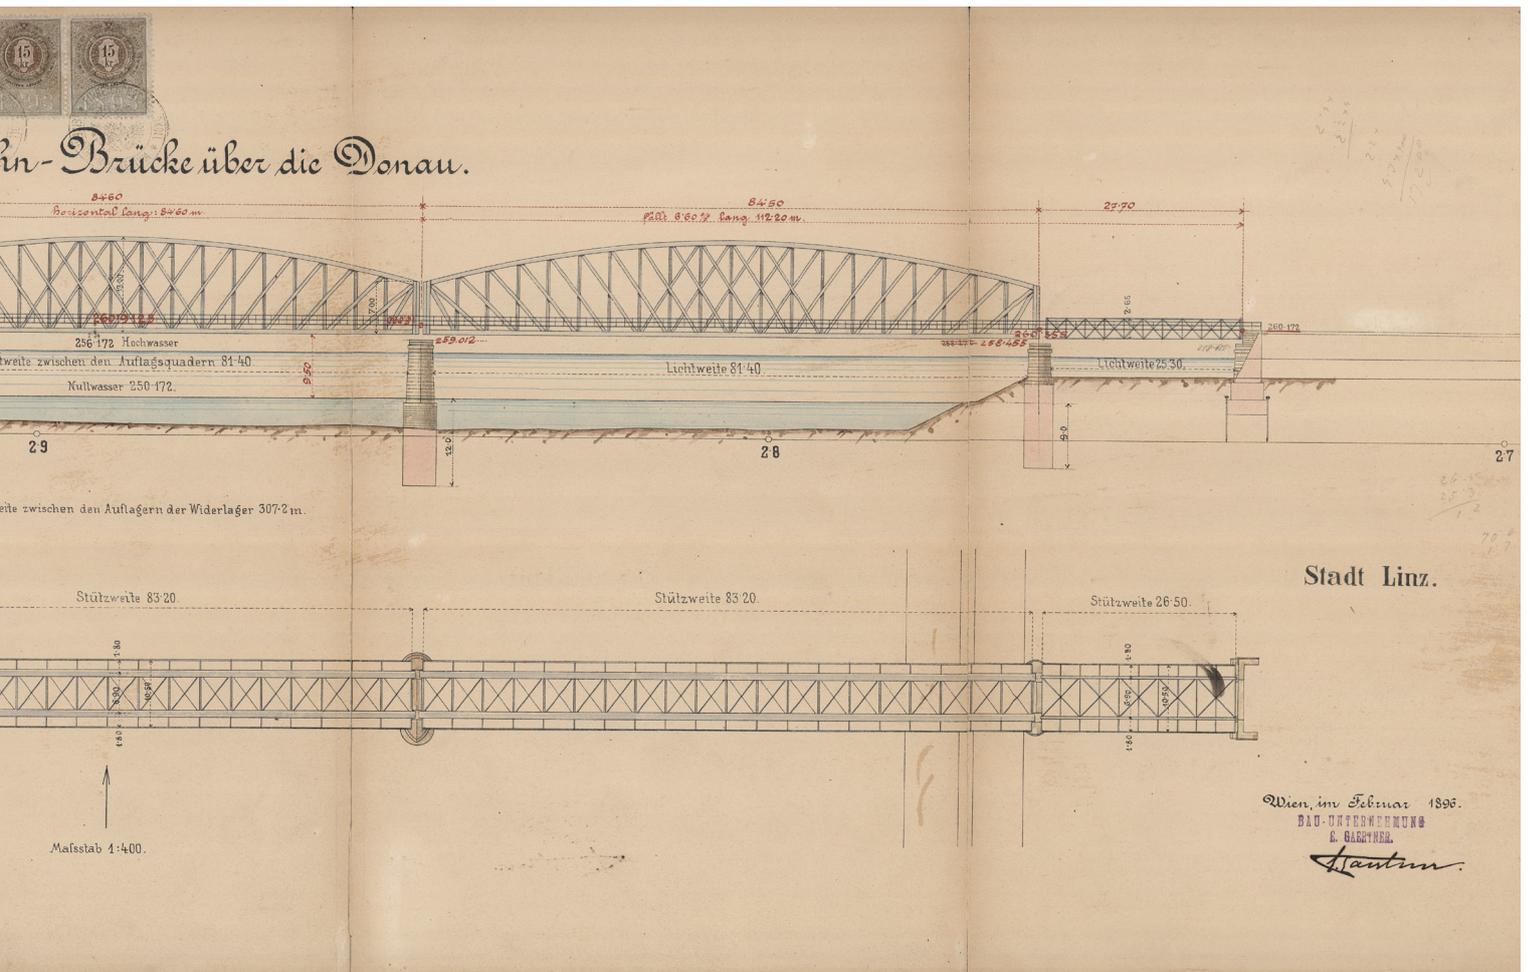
Ansicht und Grundriss, Planmaterial von E. Gaertner, 1896
